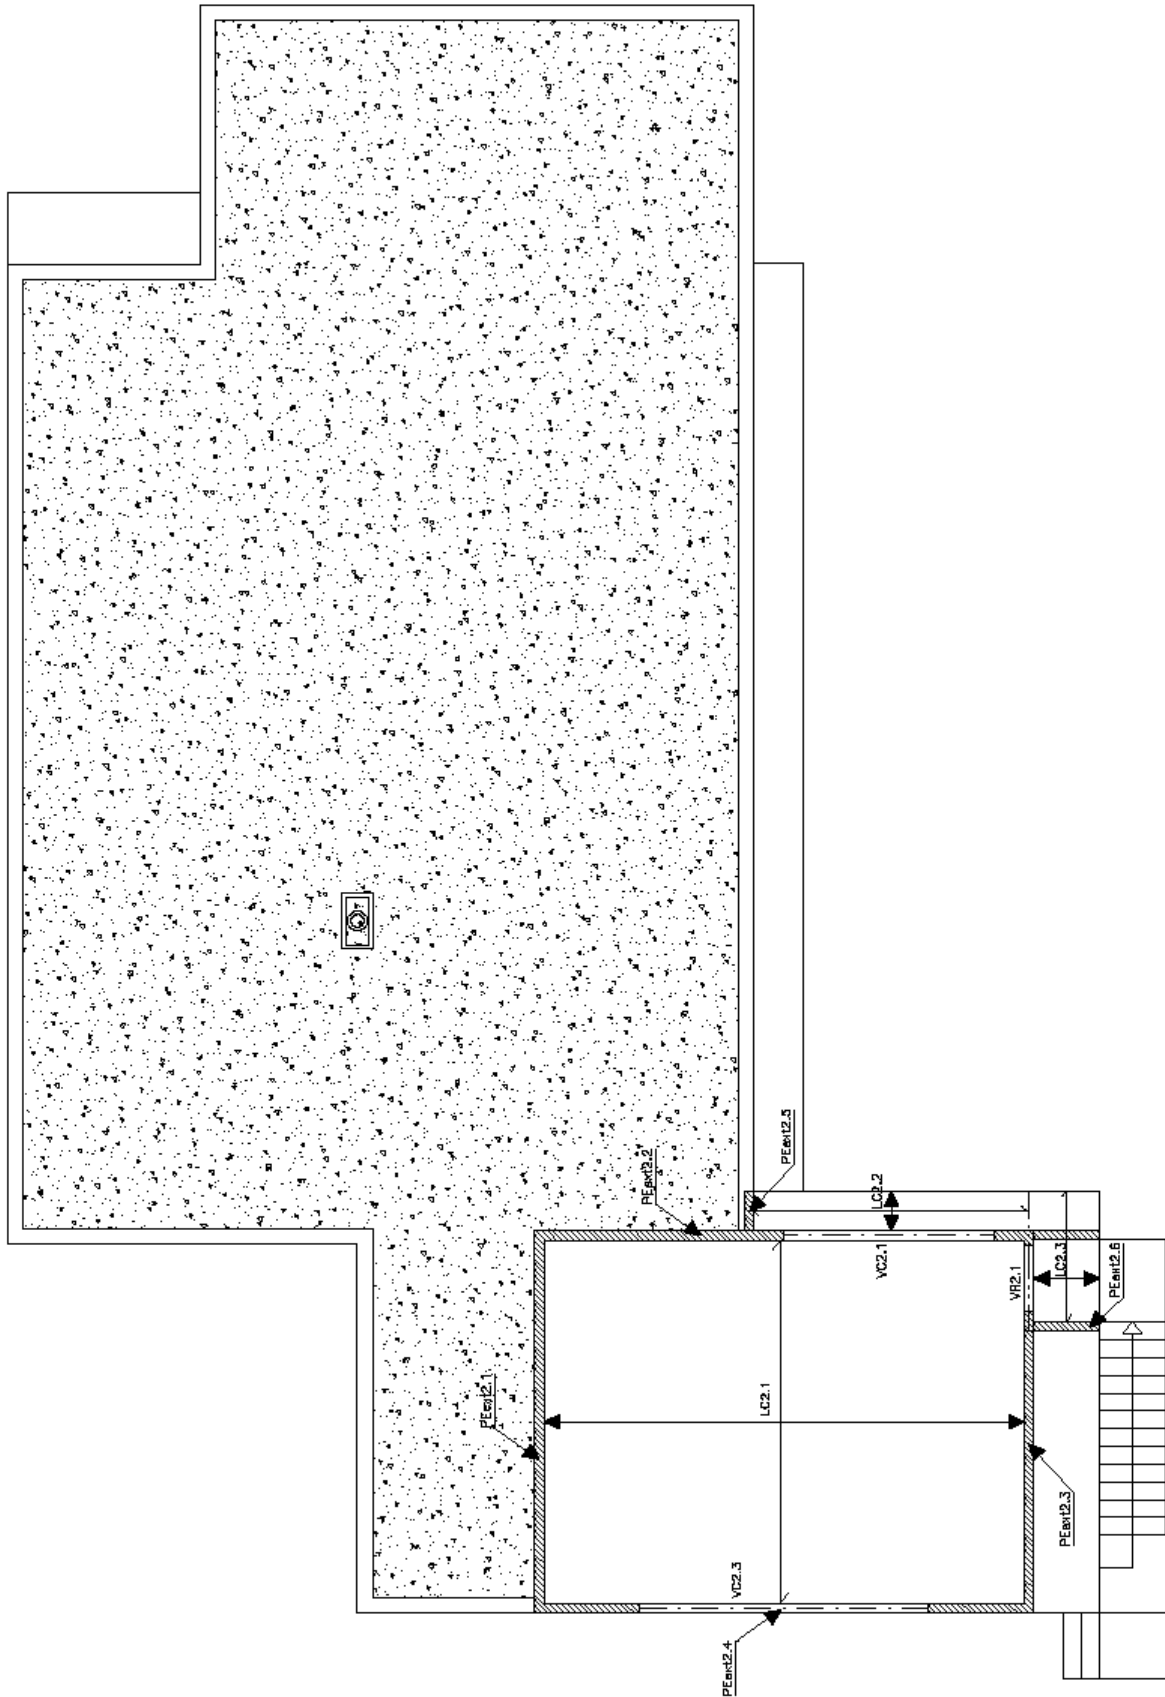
Planta do 1º andar das lajes de cobertura (LC), vigas de reforço (VR) e vergas (vigas de cabeceira - VC).
